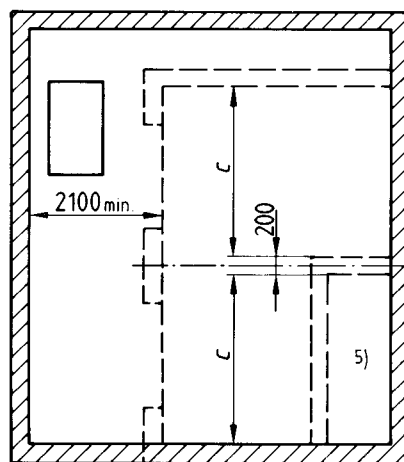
Gemeinsamer Triebwerksraum für Aufzugsgruppen
